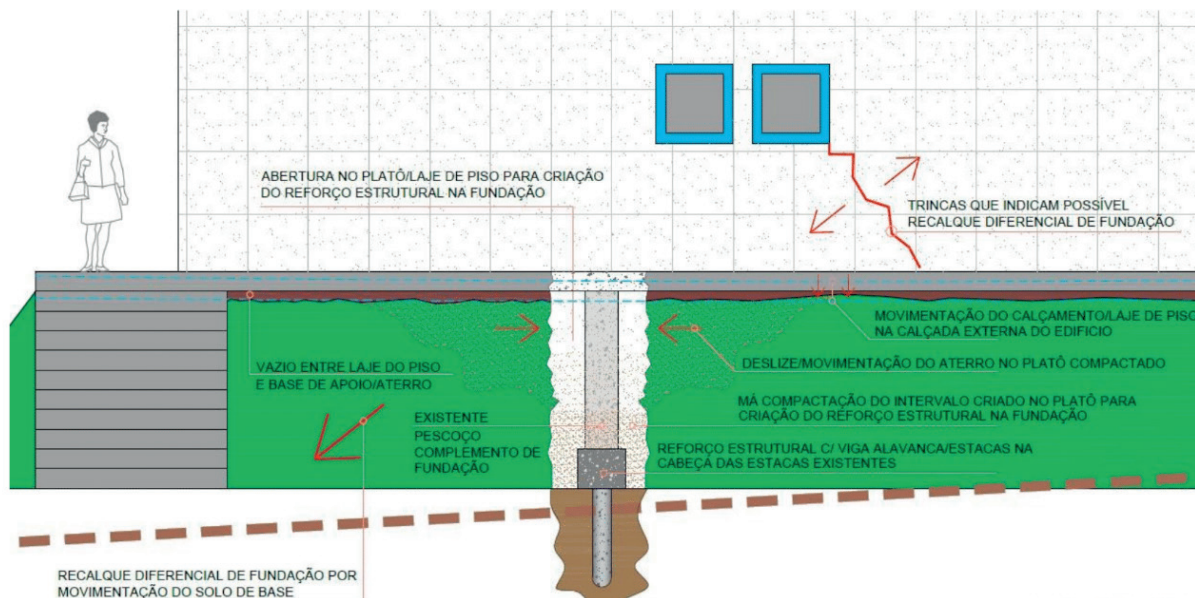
Croqui esquemático da viga alavanca executada como reforço.
